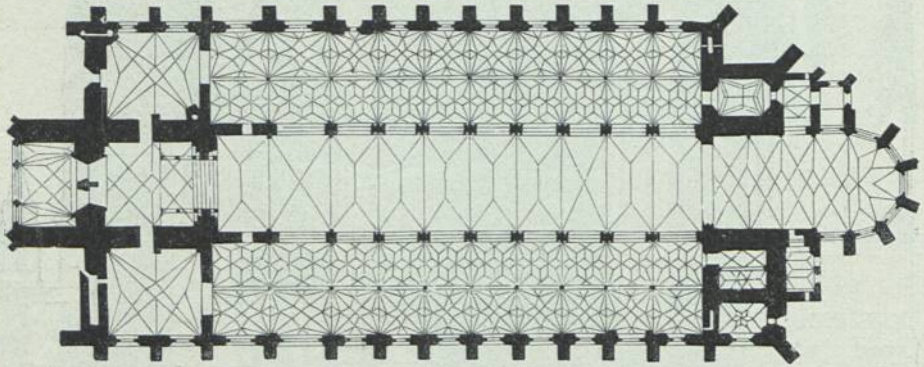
Grundriss des Münsters zu Ulm
